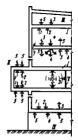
Схема распределения воздействий среды из перекрытия и перегородки:
